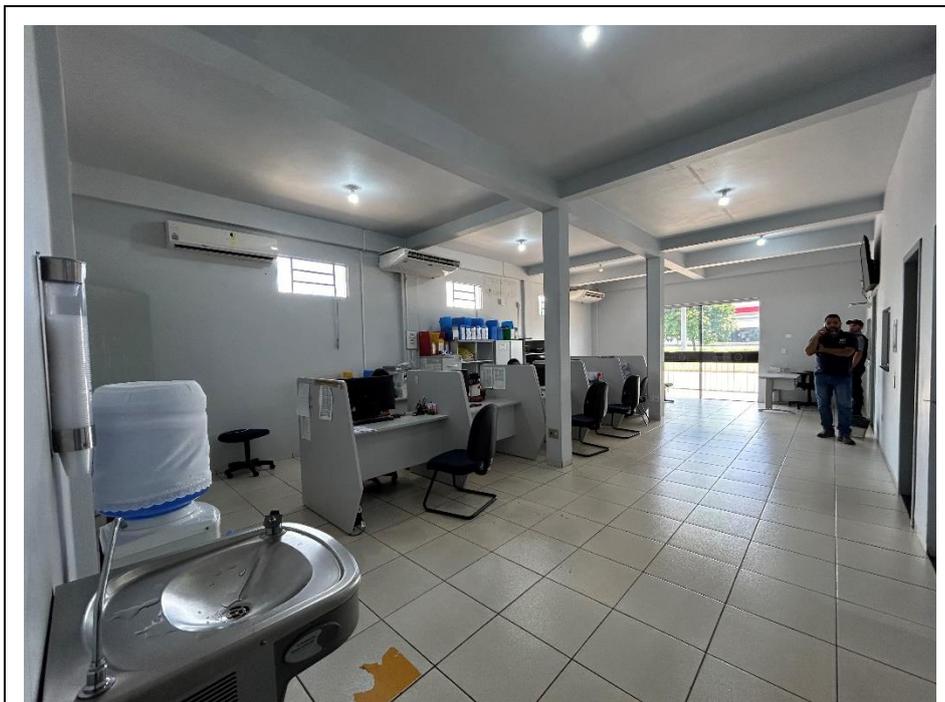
Prédio da CRT em Tapurah – Sala de atendimento – Vista a partir do hall de acesso ao banheiro PCD. Foto em 07/03/2024.
